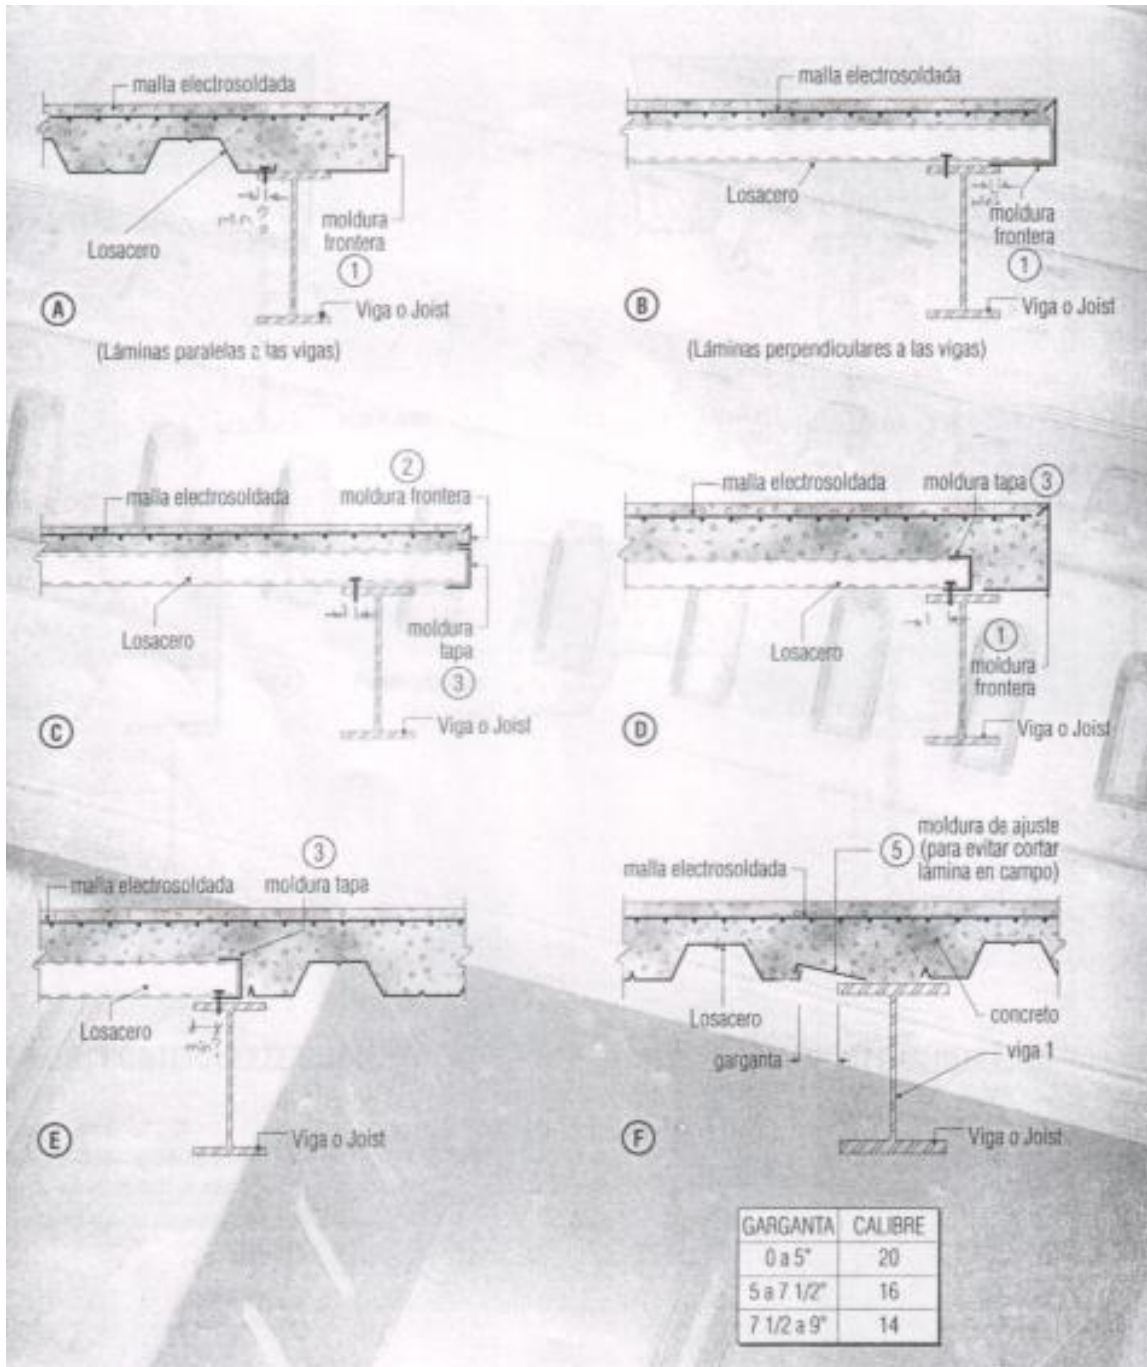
Detalle en bordes (aplicables con o sin conectores).
